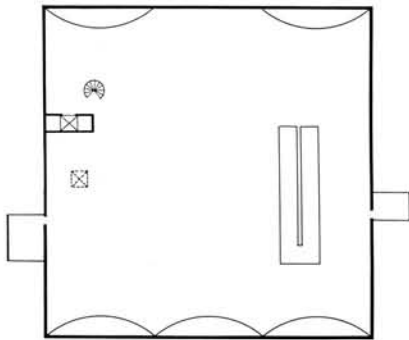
4.º PAVIMENTO - MEZANINO
